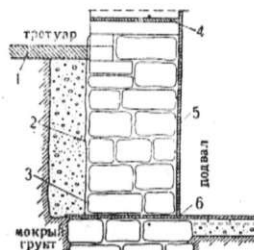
Бутовый фундамент, изолированный от грунтовых вод: 1—бетон (10 см), 2—мятая глина (10 см), 3—смола, 4—изолирующий слой асфальта, 5—перезитовая штукатурка, 6—перезитовая штукатурка или асфальт.
